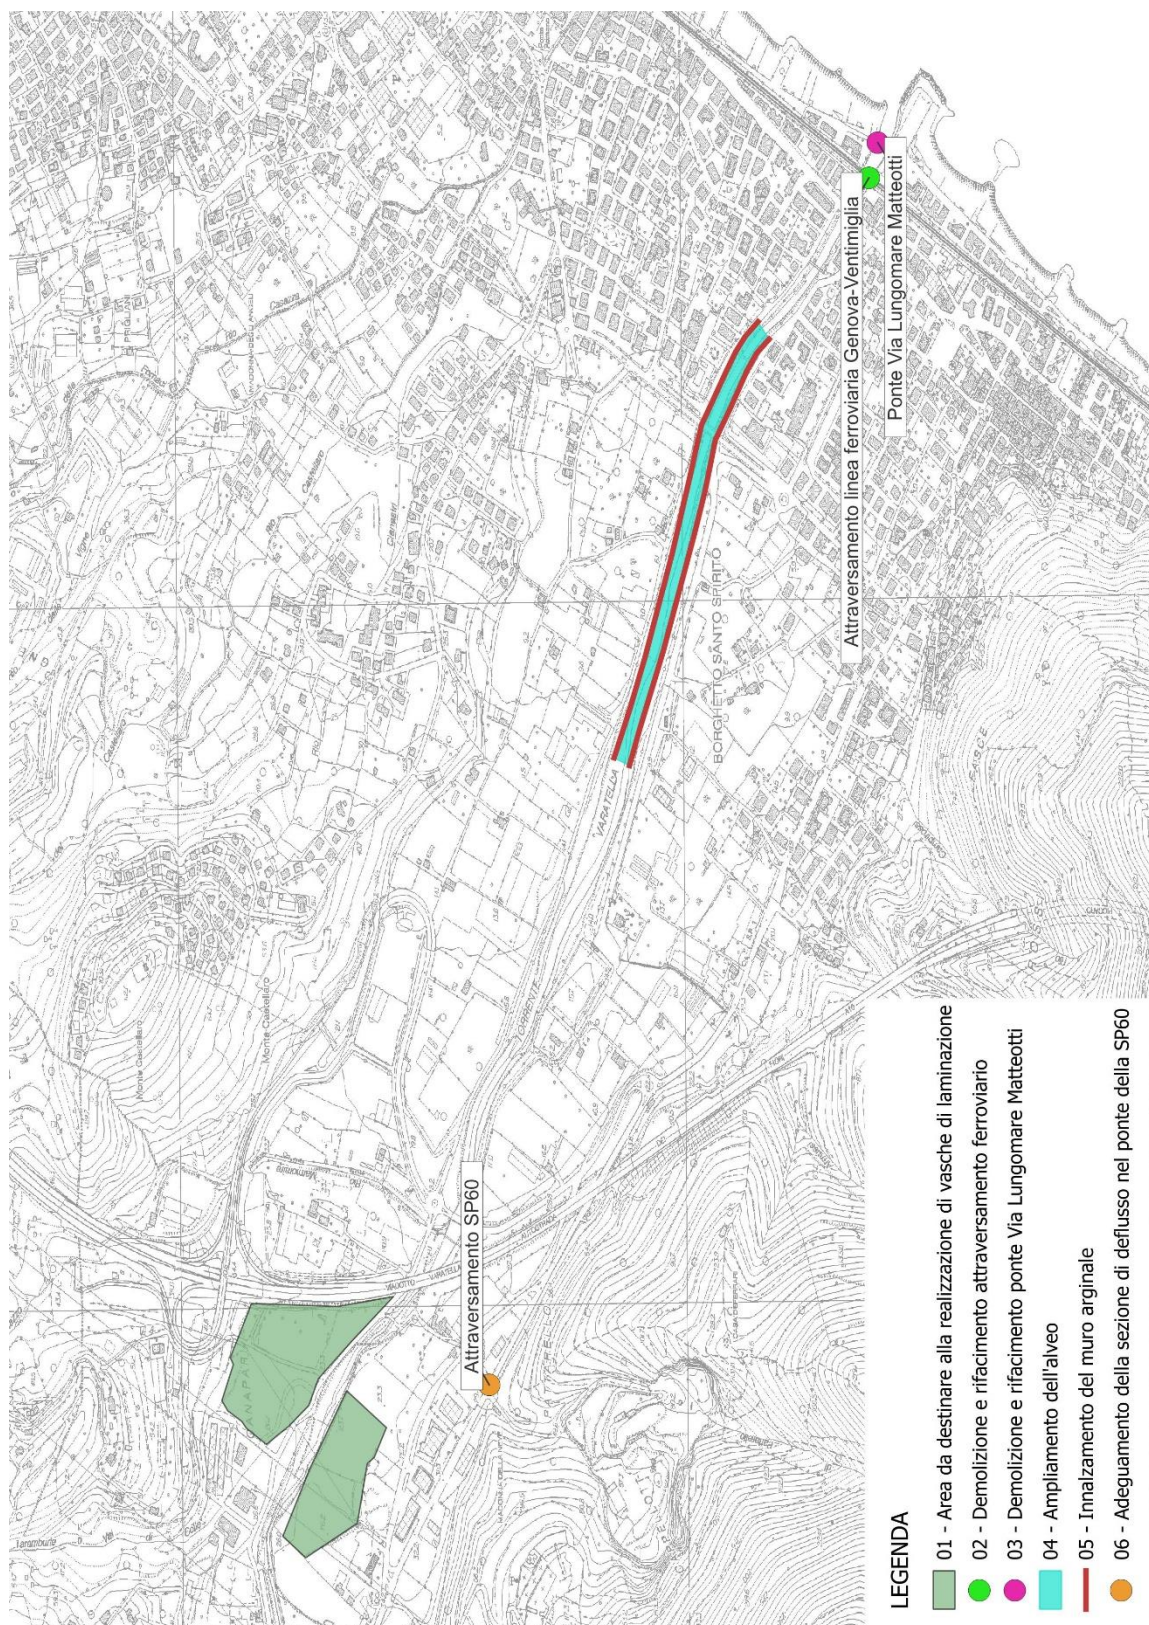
Indicazione planimetrica delle misure di intervento proposte.
